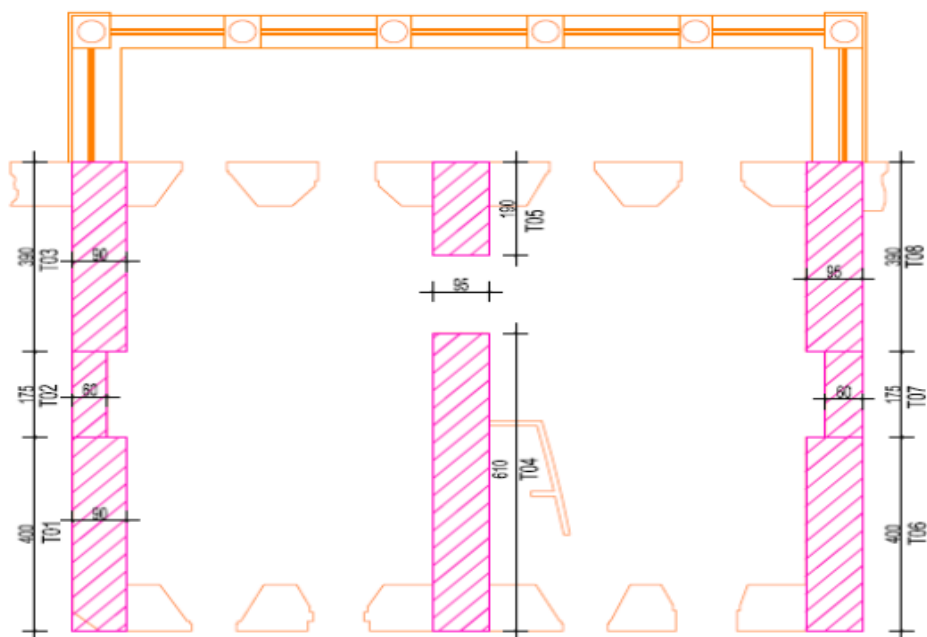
Dispunerea elementelor structurale – șpaleti din zidarie pe direcție transversală
